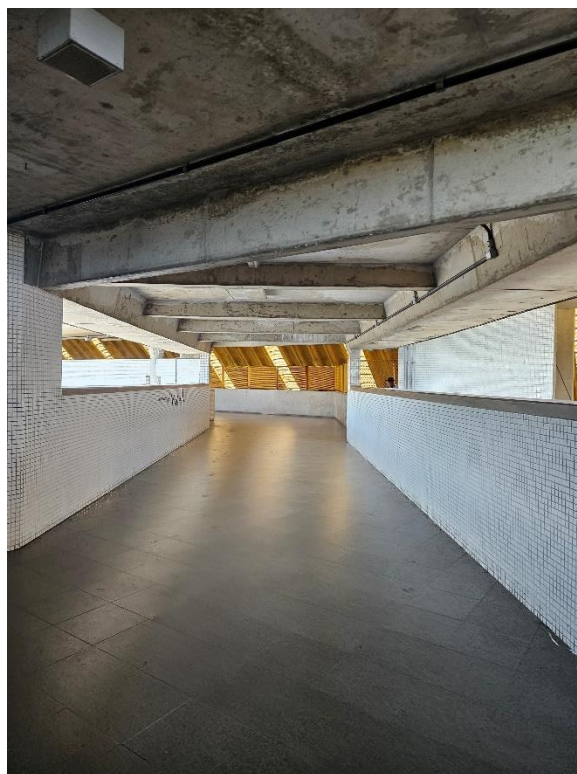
Passarela de Transposição das Plataformas – Infiltrações, Pichações e Ausência de Rota Tátil
